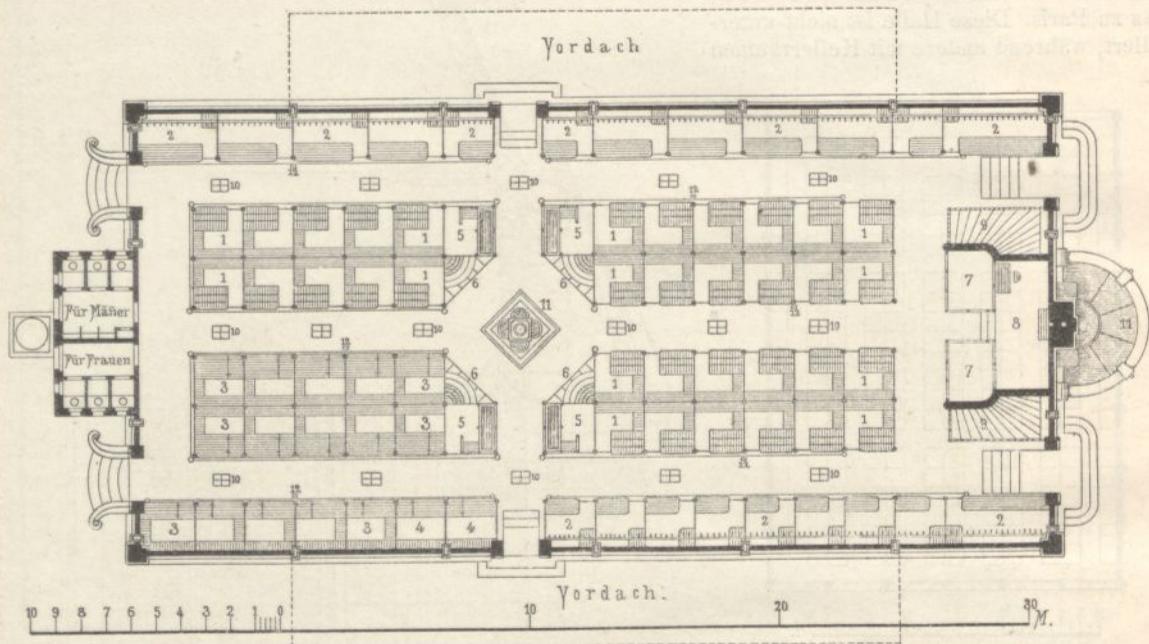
Markthalle zu Grenoble. Erdgeschoss.
